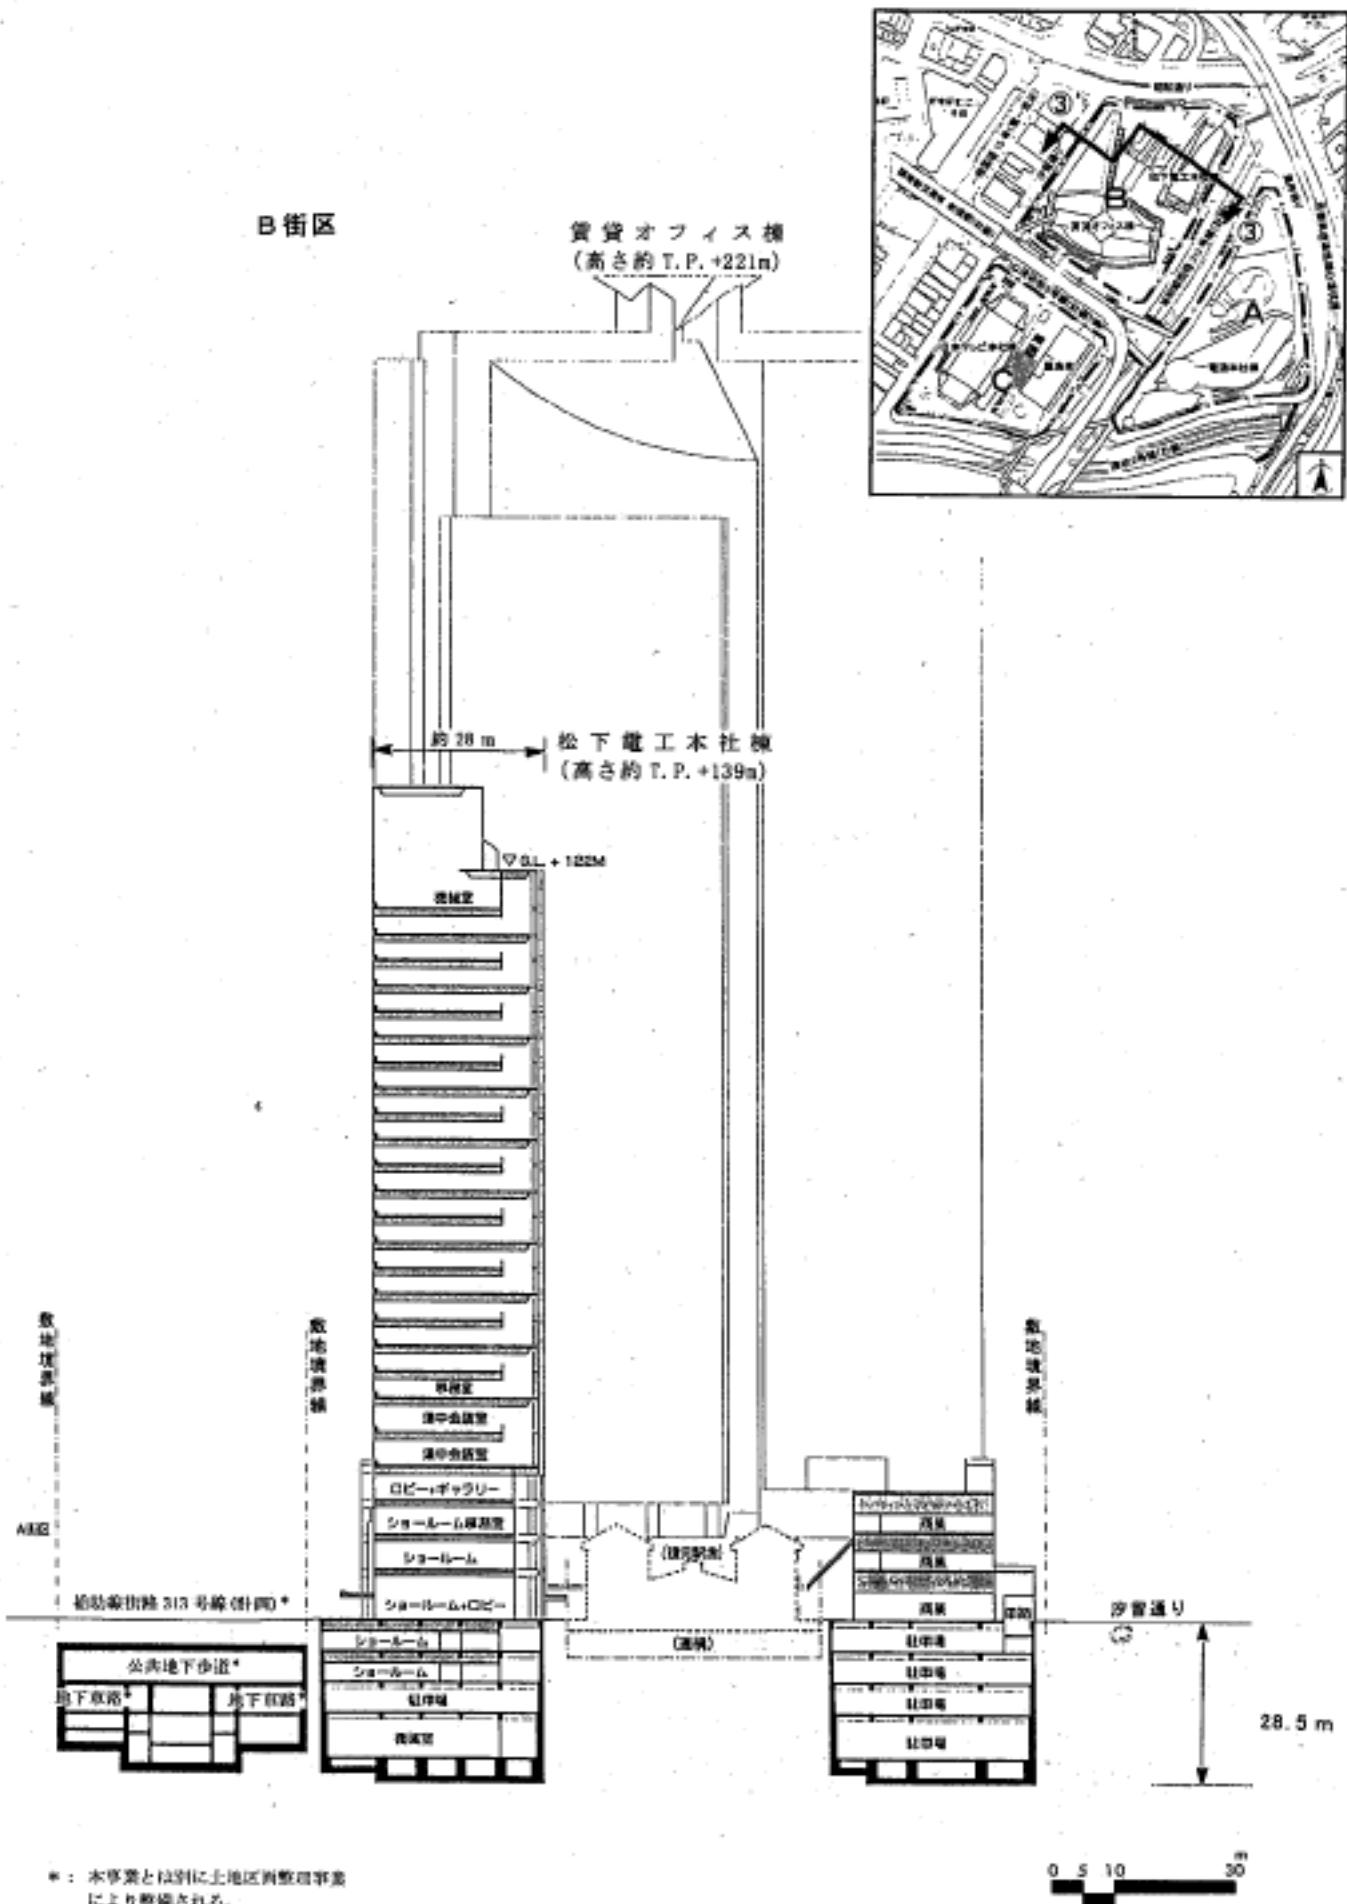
(2) 計画建築物断面図(②—②'断面)
